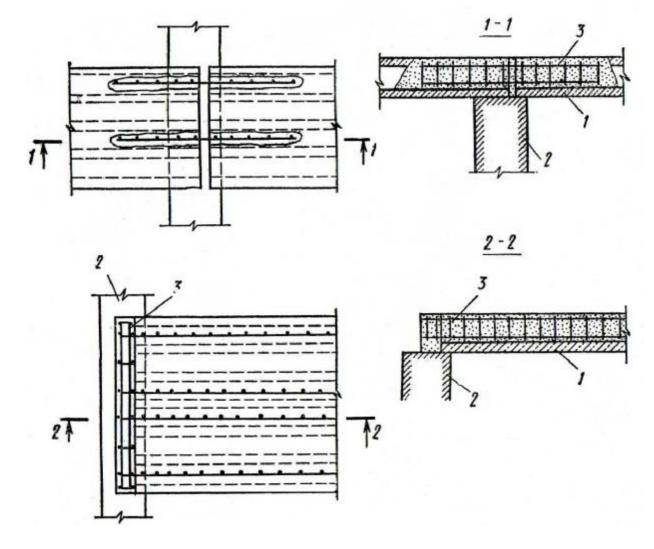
Усиление опорных частей многопустотных плит: 1 – усиливаемая плита; 2 – опора; 3 – арматурный каркас усиления
